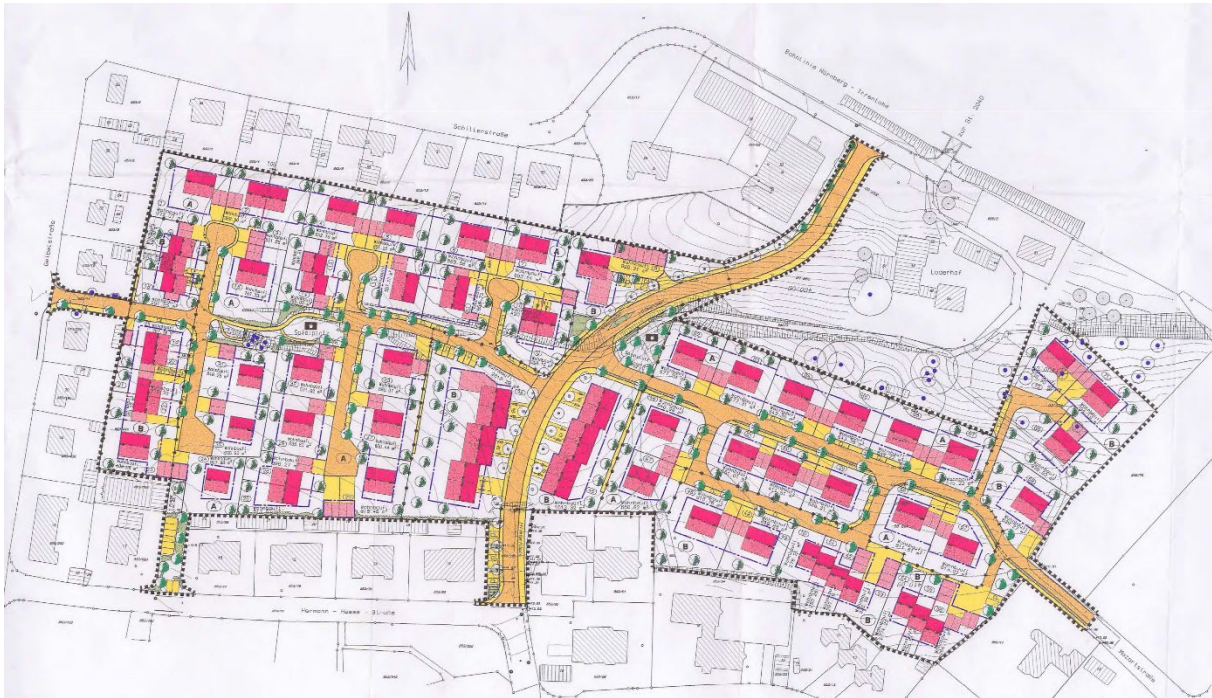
Lageplan des rechtsgültigen Bebauungsplans „Loderhof BA III“ (ohne Maßstab)
